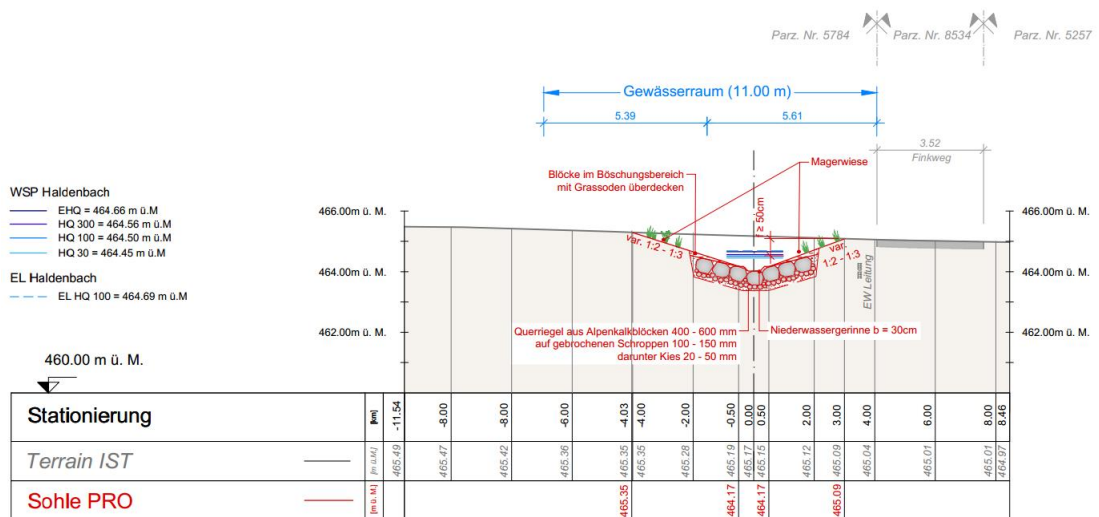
Typisches Querprofil entlang des Finkwegs (Ausschnitt aus Plan Nr. W2444.32.301)
